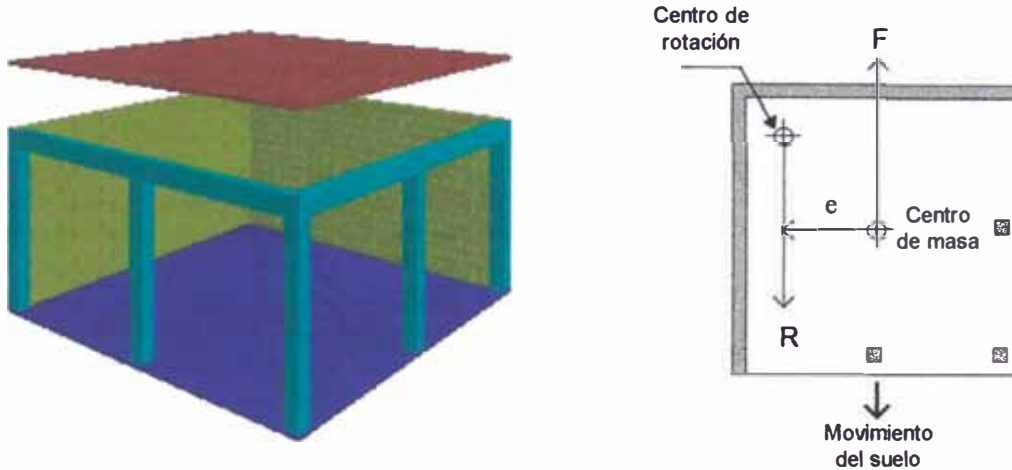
Torsión en planta por resistencia horizontal desequilibrada. La fuerza resistente R y la fuerza de inercia F actúan excéntricamente en vez de encontrarse alineadas.
